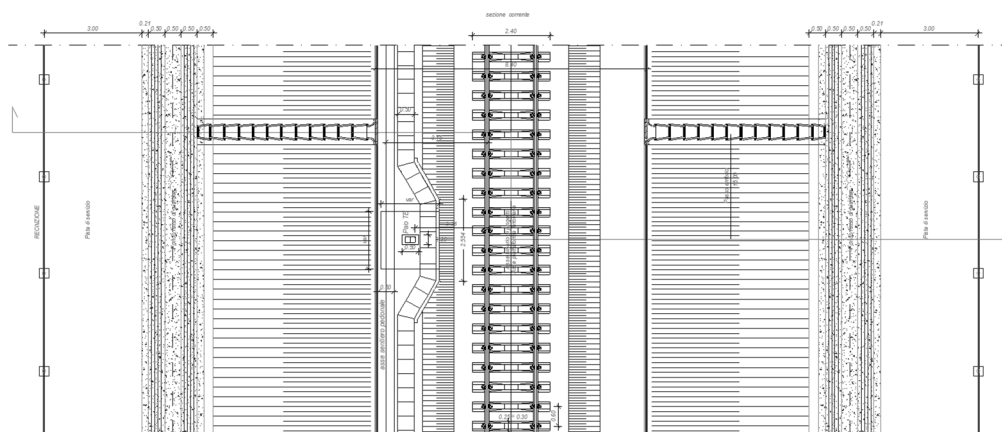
Stralcio planimetrico per sezione tipo ferroviaria in rilevato a singolo binario (piattaforma in retto) con  $H_{ri} \leq 6,00$  m
